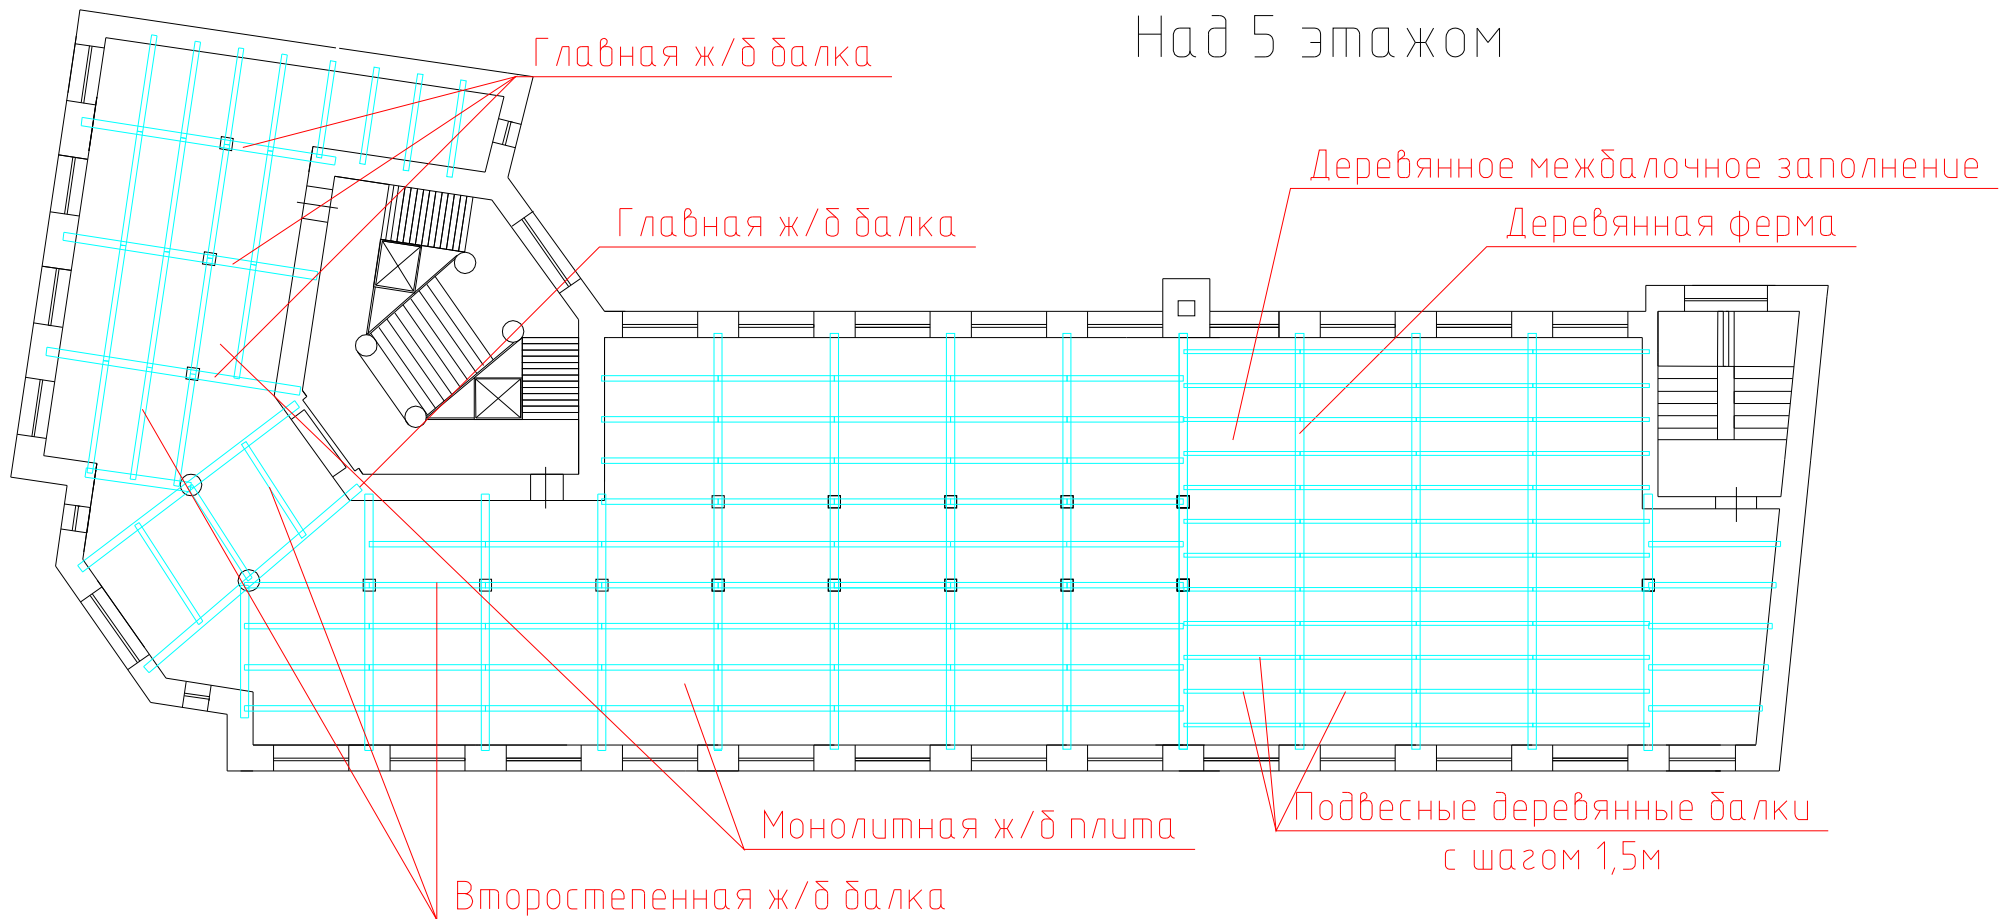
Схема главных и второстепенных балок монолитного ж/б перекрытия за исключением осей «9–10/А–Г» и подвесного деревянного перекрытия в осях «9–10/А–Г» над пятым этажом
